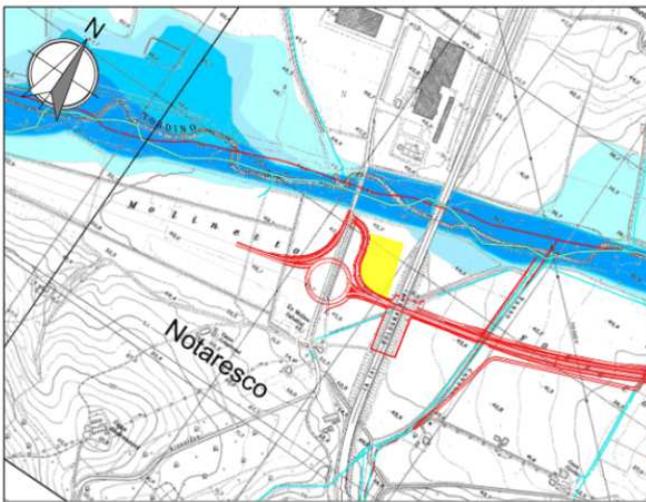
Dettaglio sovrapposizione Area Cantiere Logistico CL03
